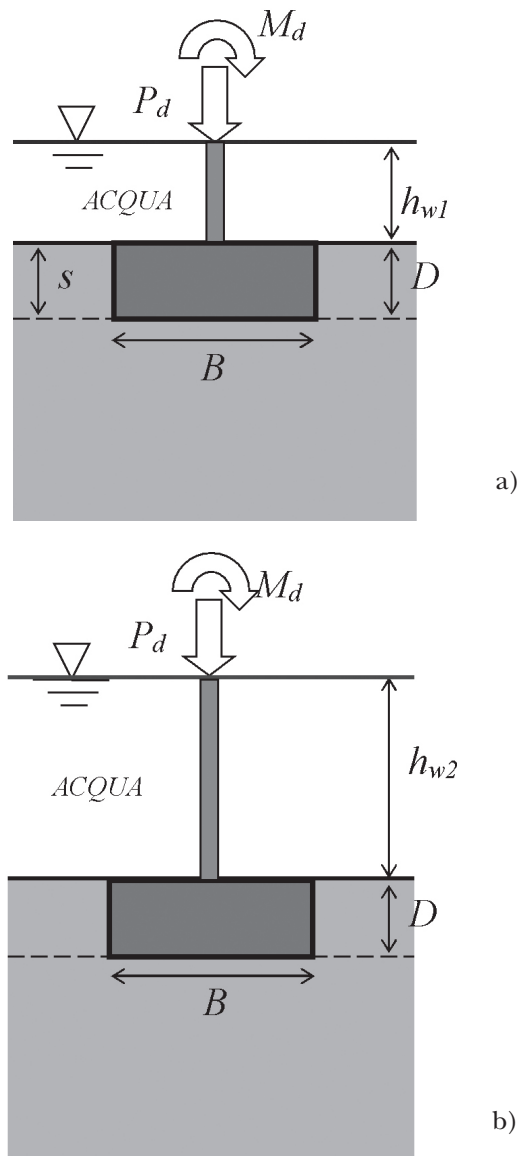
Schema delle due fondazioni analizzate : a) Fondazione #1; b) Fondazione #2.
